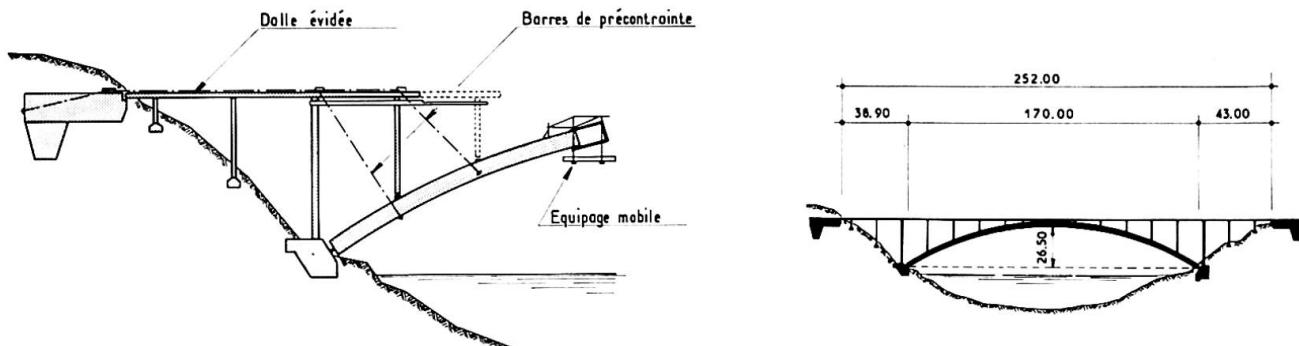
Construction du pont de HOKAWAZU (Japon)
